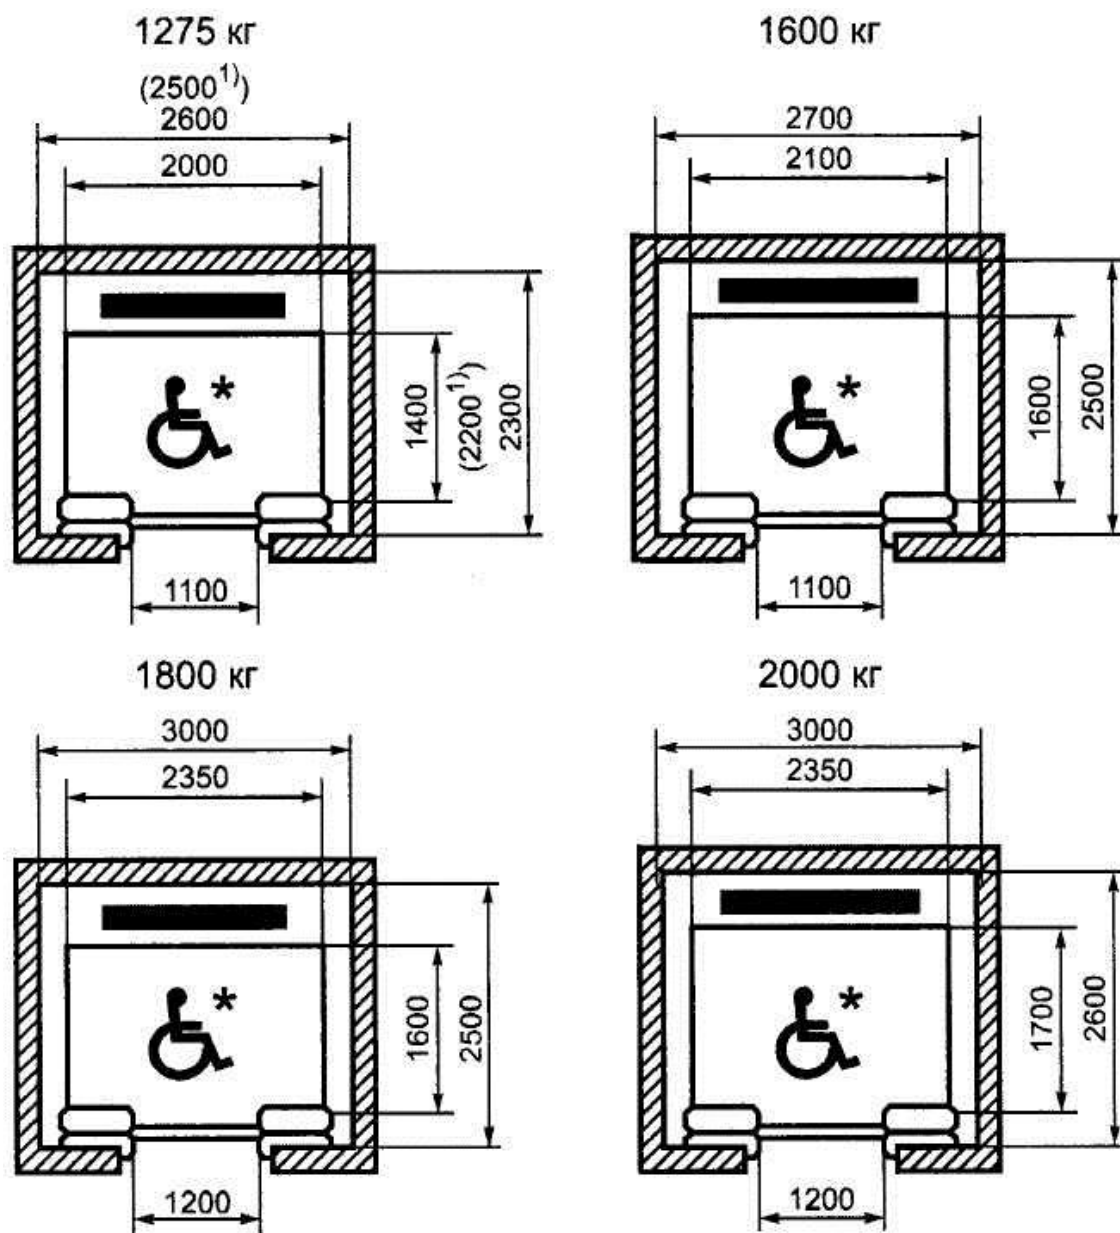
Габаритные размеры лифтов для инвалидов – колясочников.
